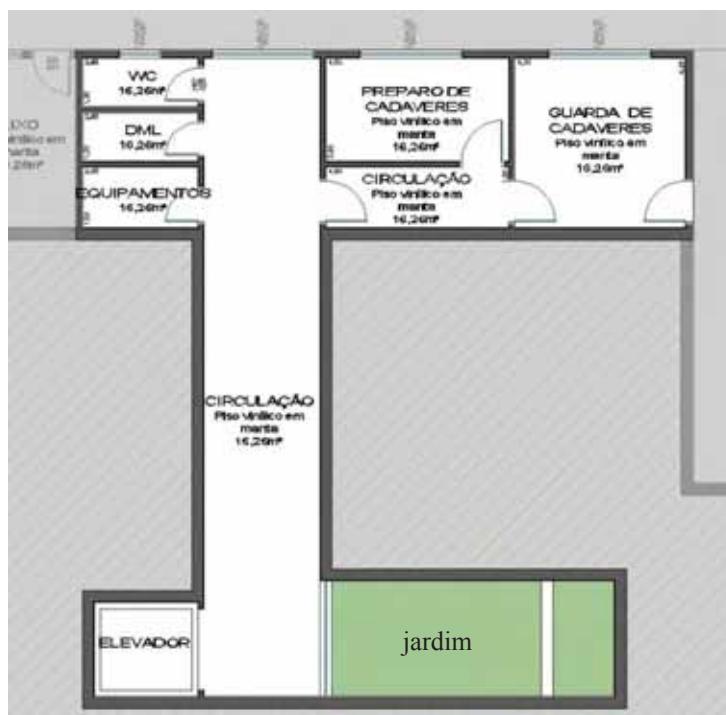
Planta do necrotério, com circulação de acesso (sem escala).
